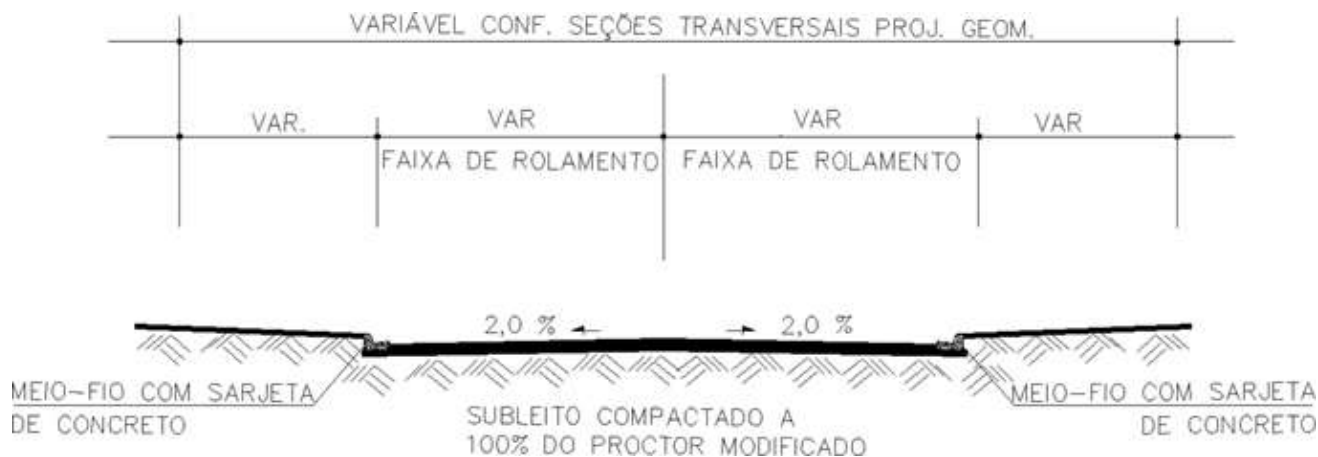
SEÇÃO TIPO DO PAVIMENTO
